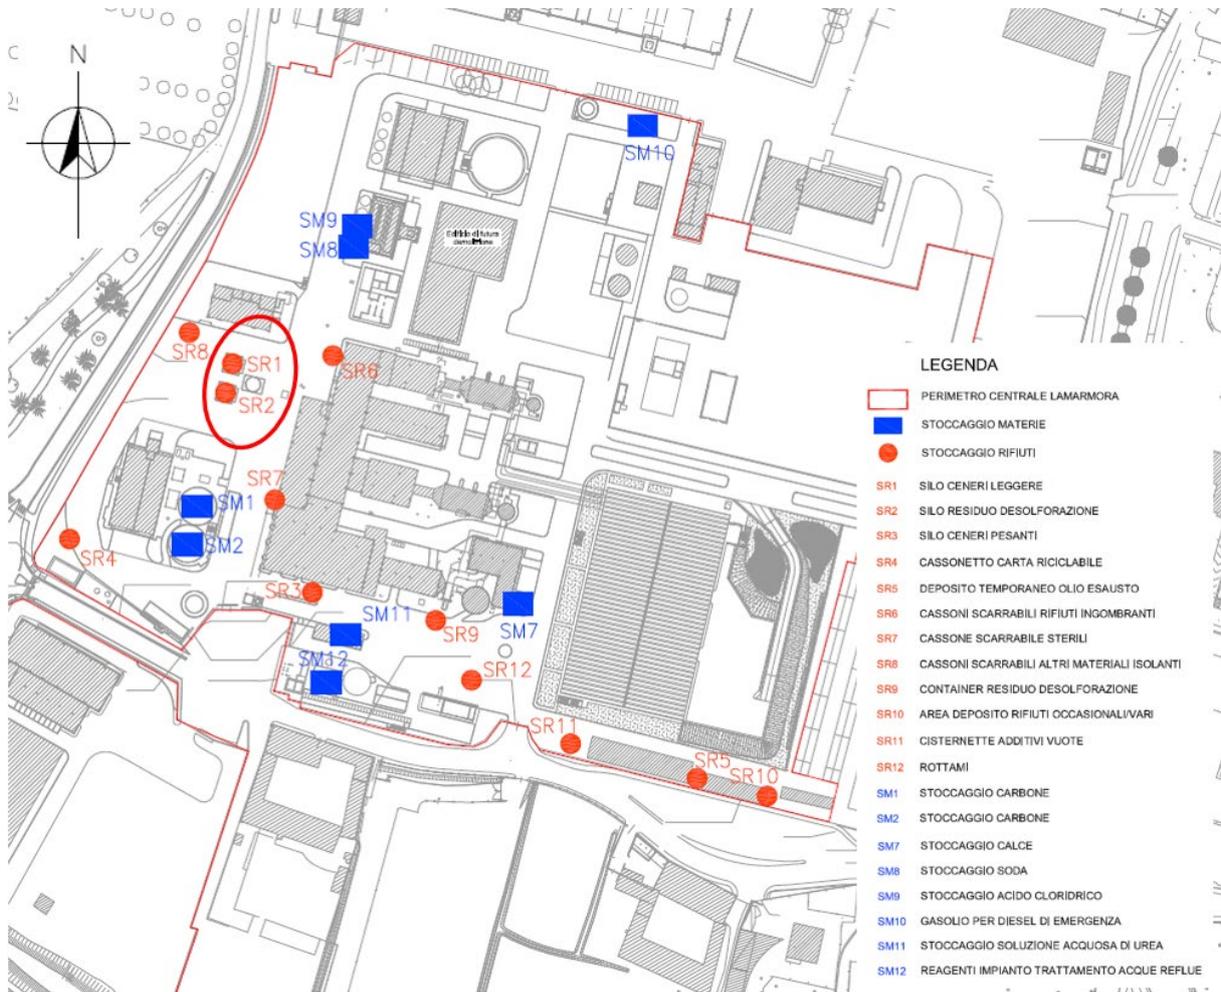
Stralcio della Planimetria con Individuazione delle Aree per lo Stoccaggio di Materie Prime e Rifiuti (Allegato B.22 alla Documentazione di Riesame AIA, 2019)
